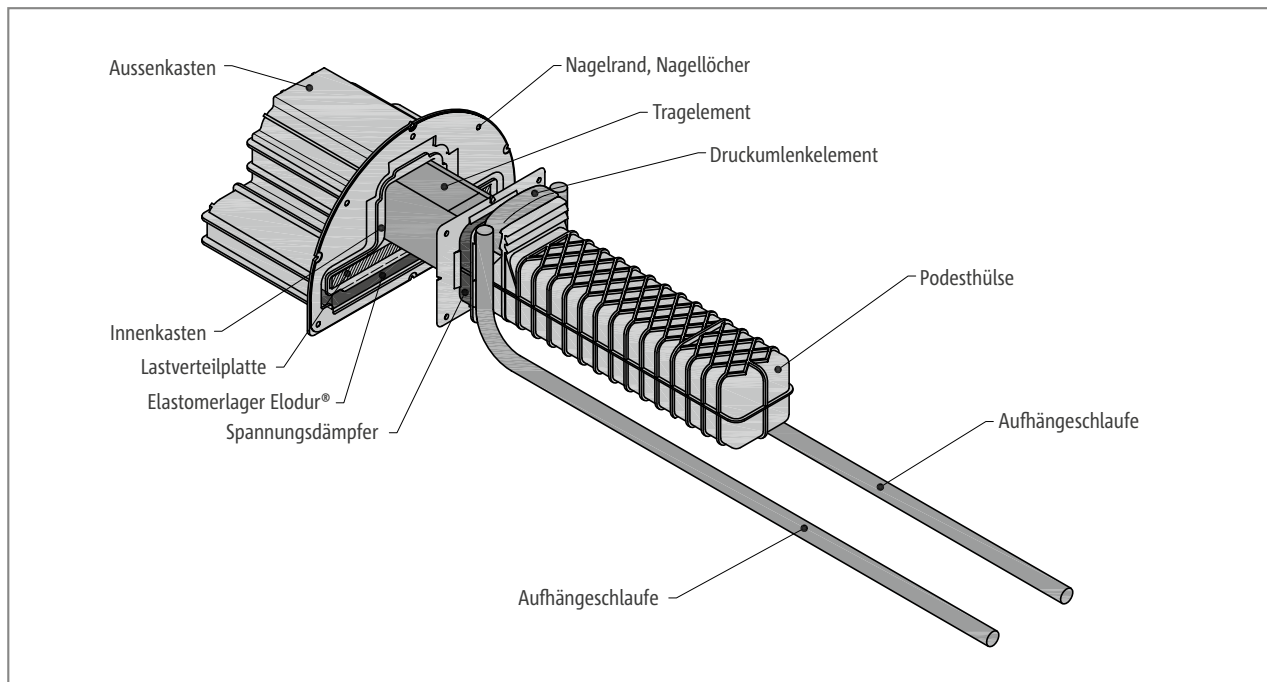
Schöck Tronsole® Typ P: Wandelement, Tragelement und Podesthülse mit detaillierter Benennung wichtiger Bestandteile
